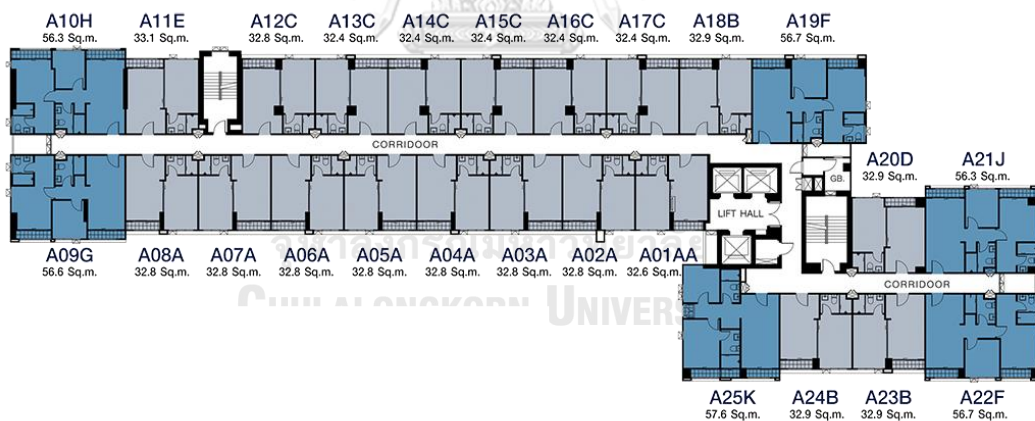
ผังรวม (Master Plan) ของโครงการเดอะ คีย์ วุฒากาศ
